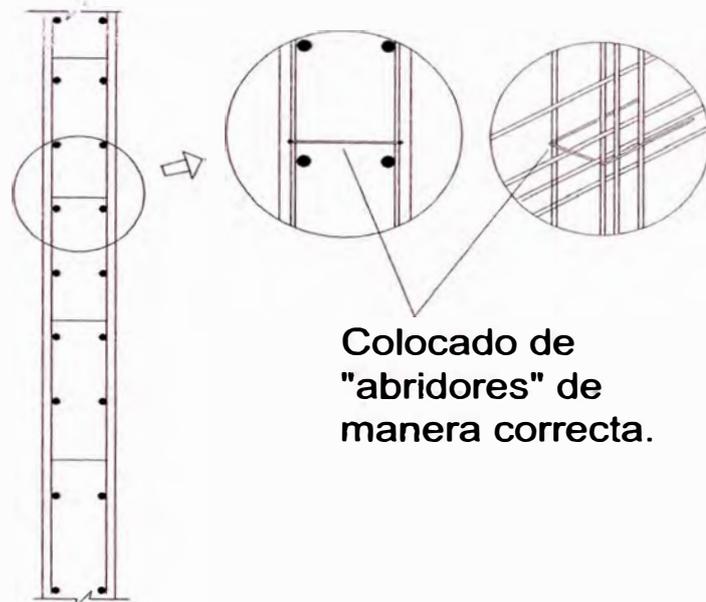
Detalle de *abridor* en muro de concreto armado. Nótese que debe confinar las varillas de acero.
